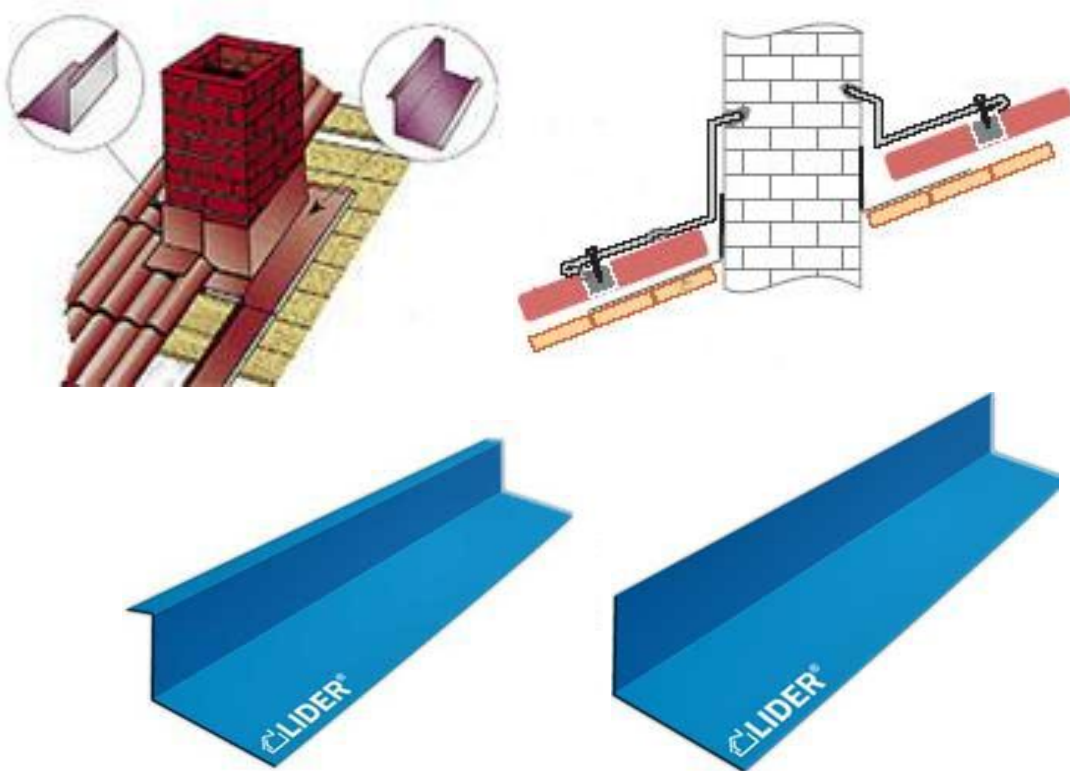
Примыкание к дымоходу, Планка примыкания со штробой и Планка примыкания без штробы
